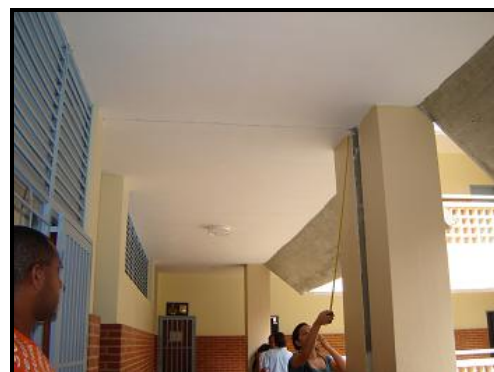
Vista general y junta de construcción entre los dos edificios con una separación de 7 cm. E. B. N. Fernando Peñalver
